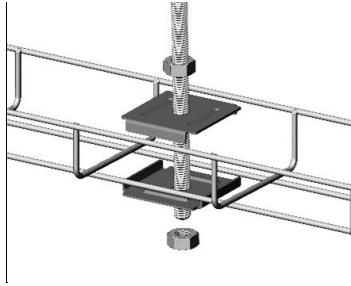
Площадка подвеса под шпильку 52x52 ЛМПРО ПжТехКабель
